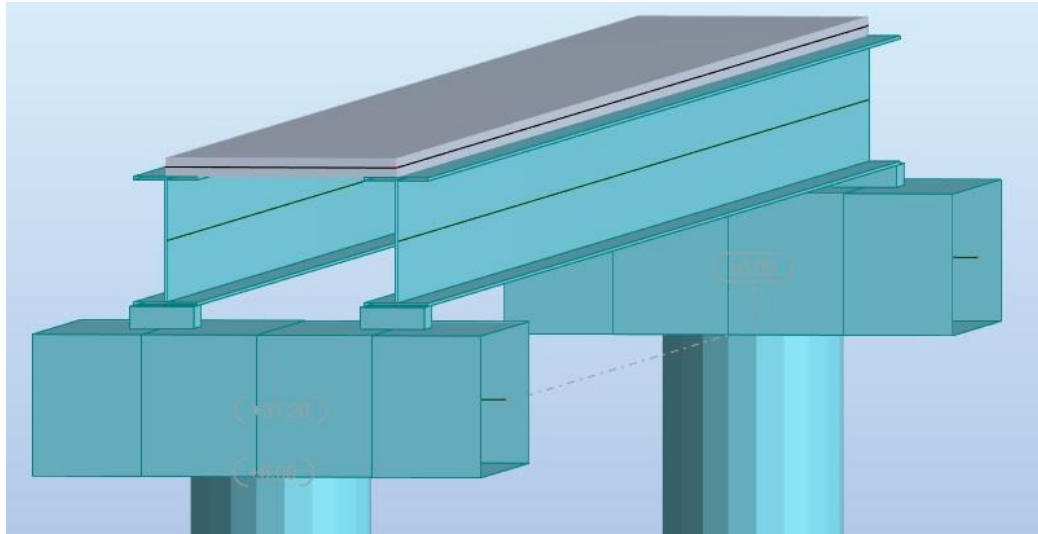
Sección transversal de viga sección compuesta con losa sin corregir.
